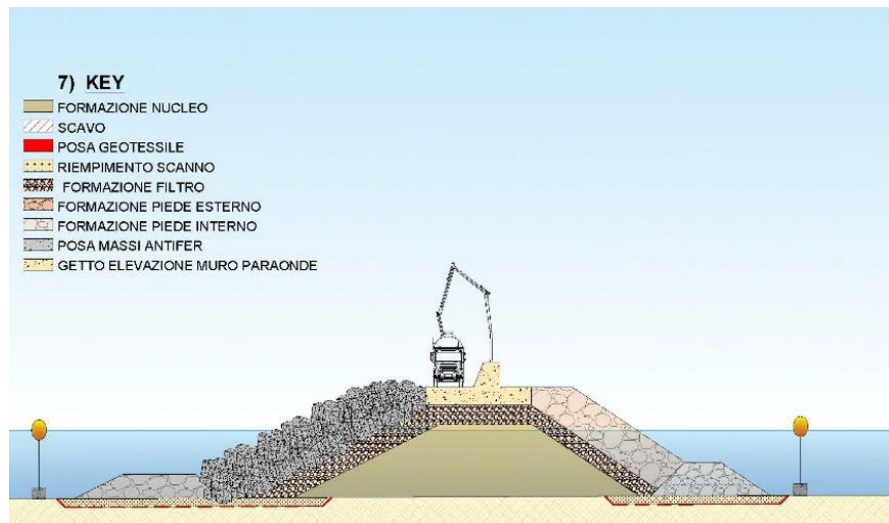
Fase 7: realizzazione elemento in elevazione del muro paraonde
